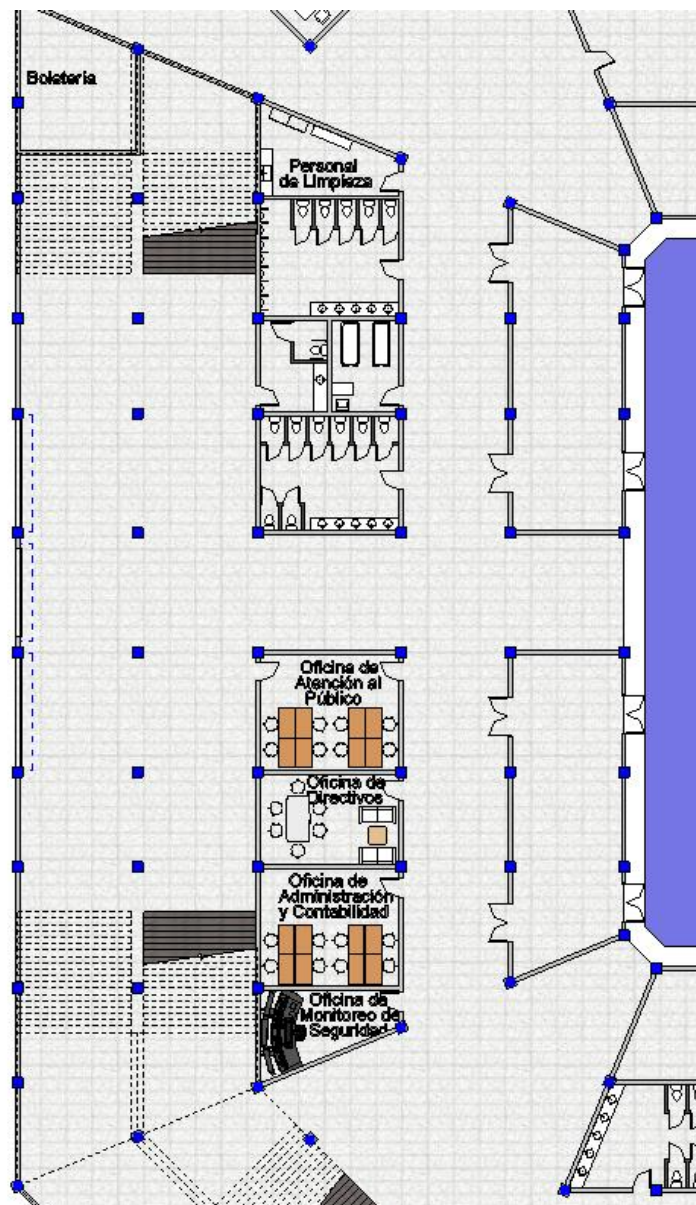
Vista en planta del sector oeste. Fuente: elaboración propia.
